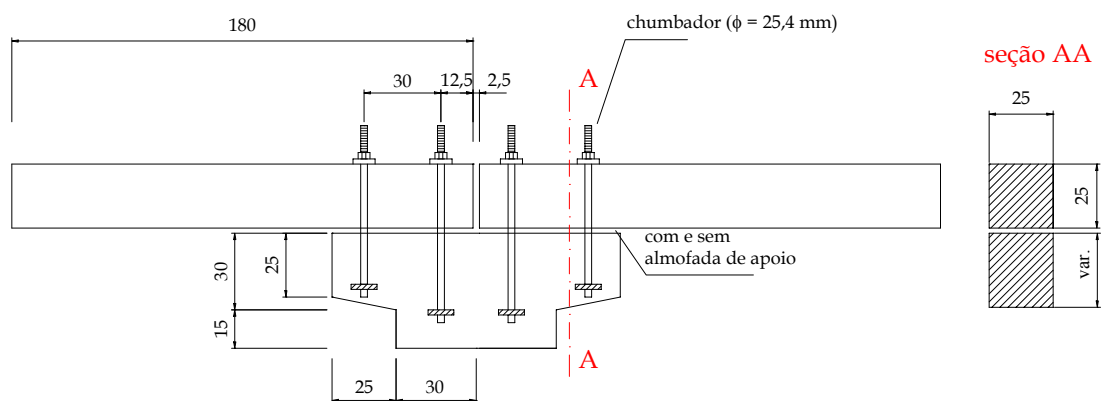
Características dos modelos 1.2 e 1.3 da ligação n°1 (dimensões em cm).
